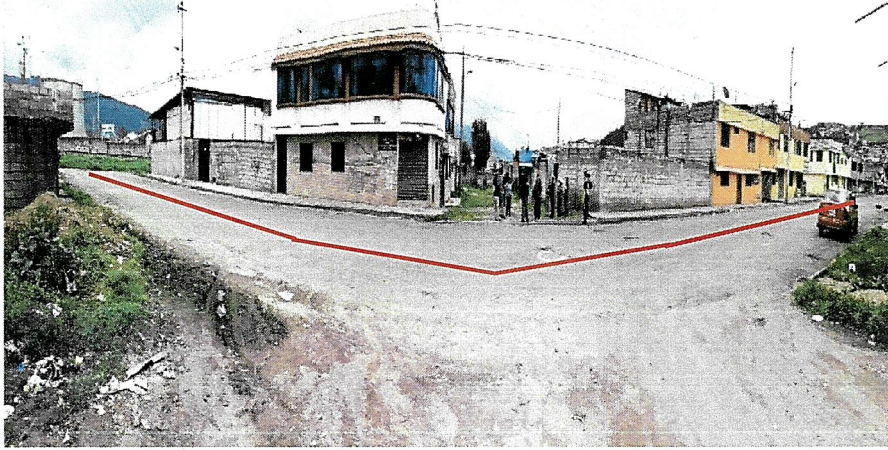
Fotografía panorámica Calle S50 – Estado actual asfaltado.
